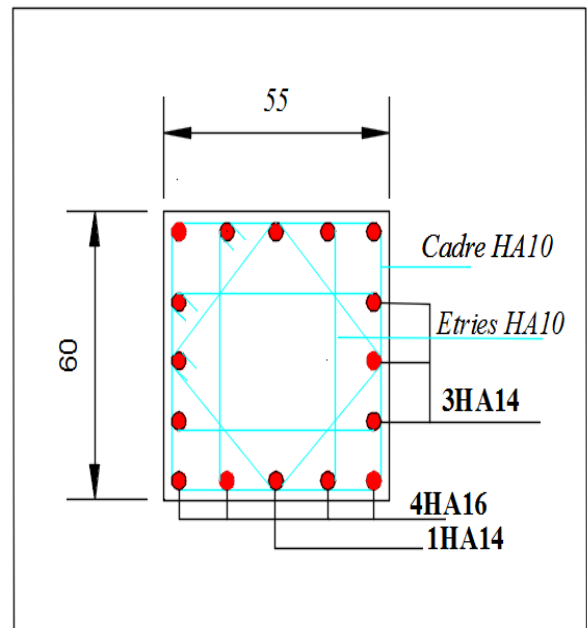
schéma de ferrailage des poteaux 4, 5^{ème} étages.
